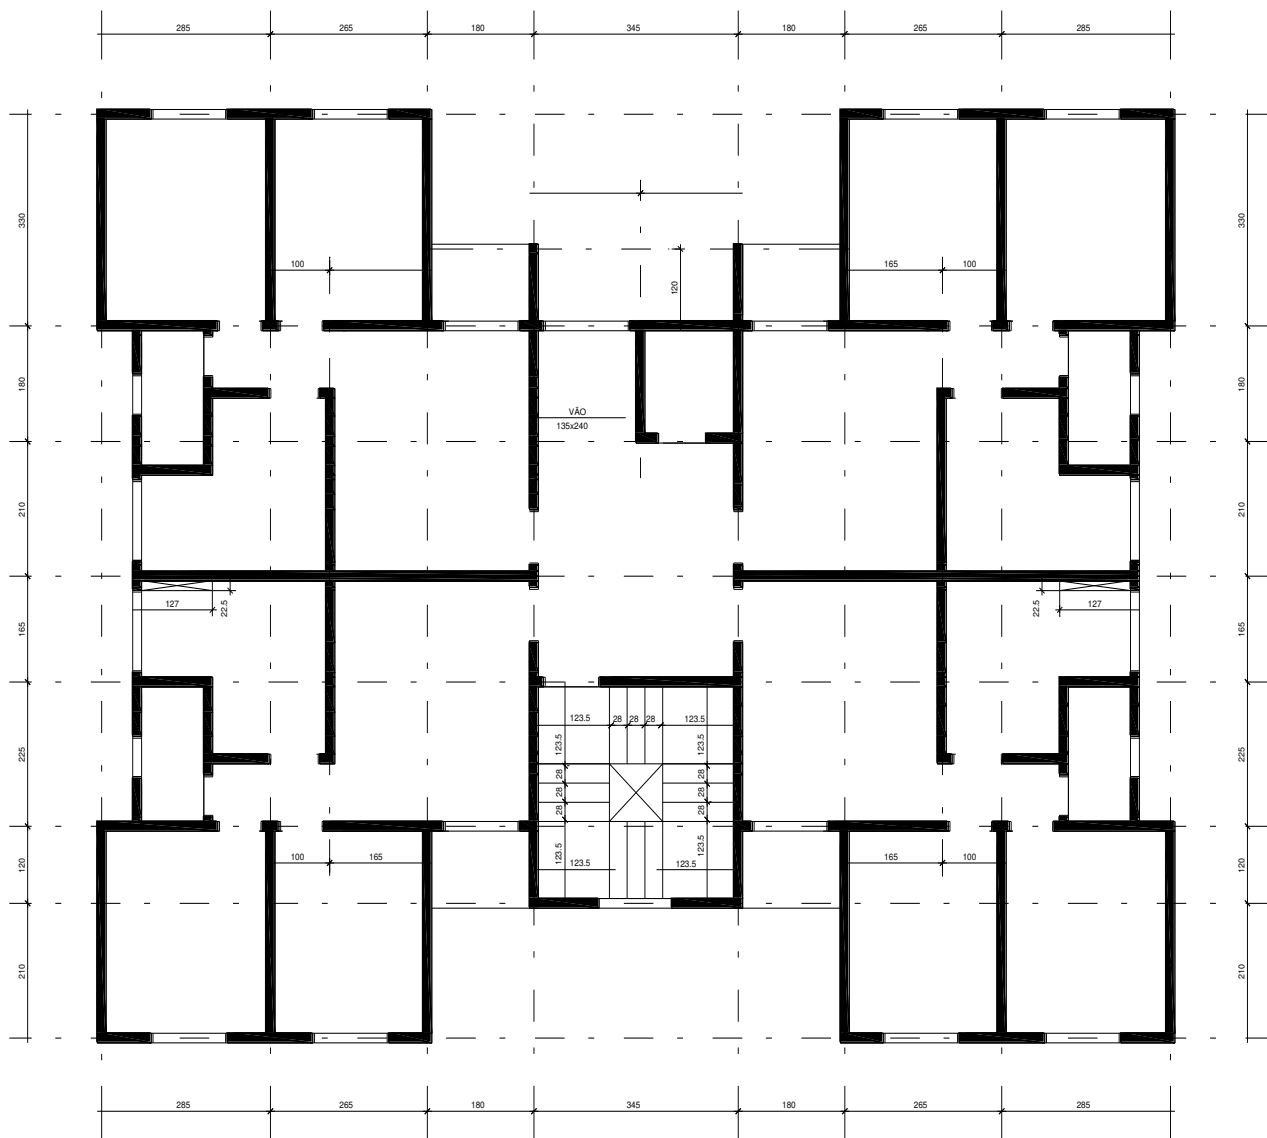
PLANTA DE FORMA DO PAVIMENTO TIPO. OPÇÃO: ALVENARIA ESTRUTURAL
